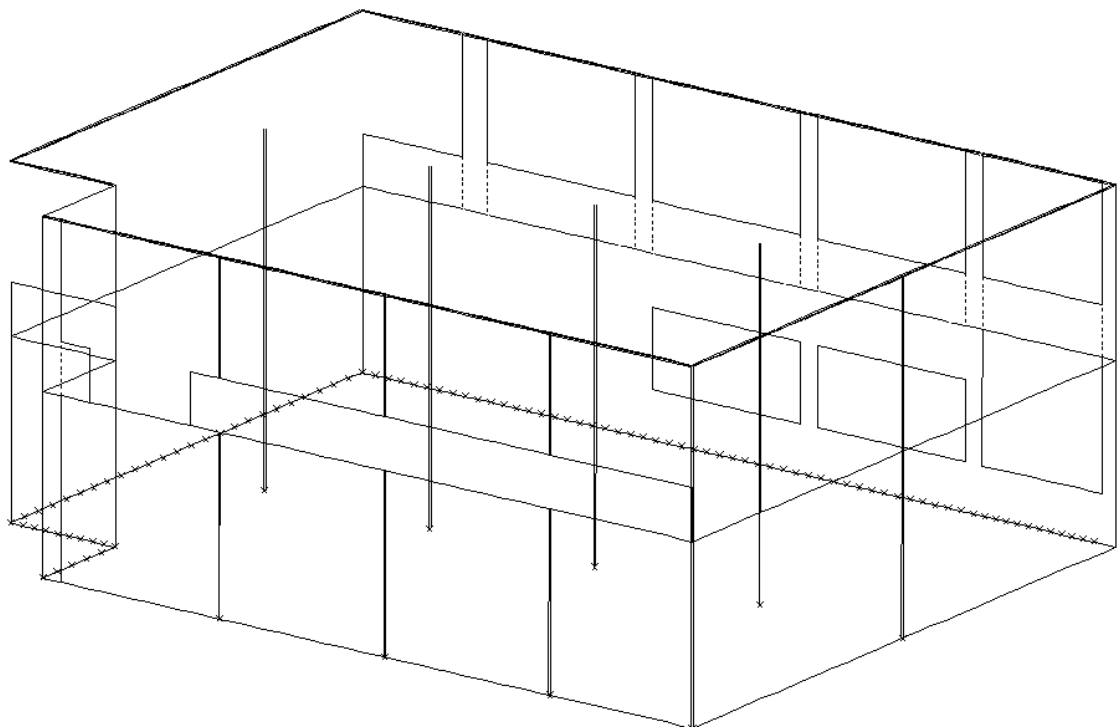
Statisches System Anbau mit Aufstockung, BV Schlosserei, Holzgerlingen
